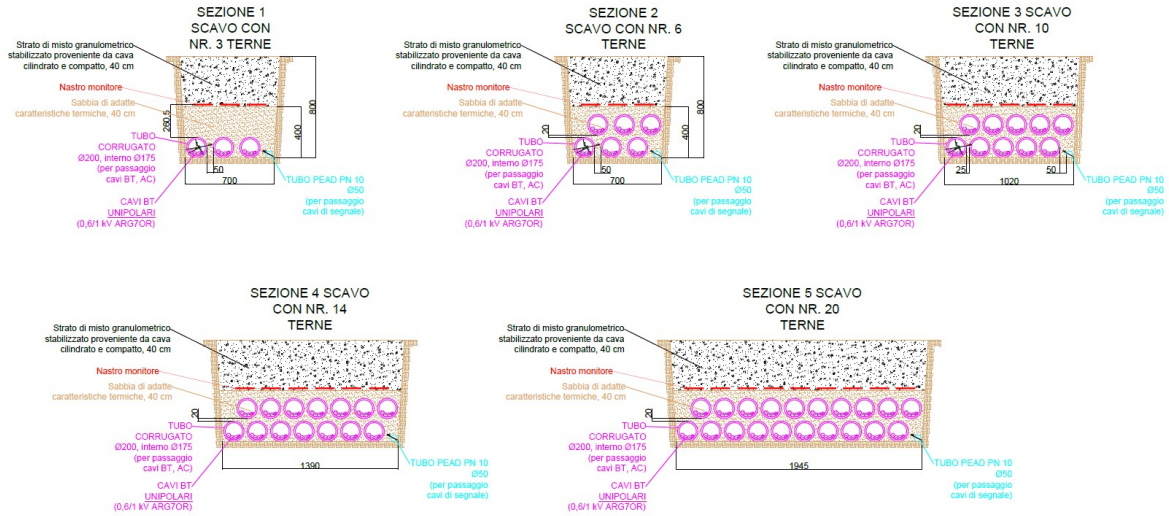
Sezione della trincea di scavo interna all'area d'impianto
